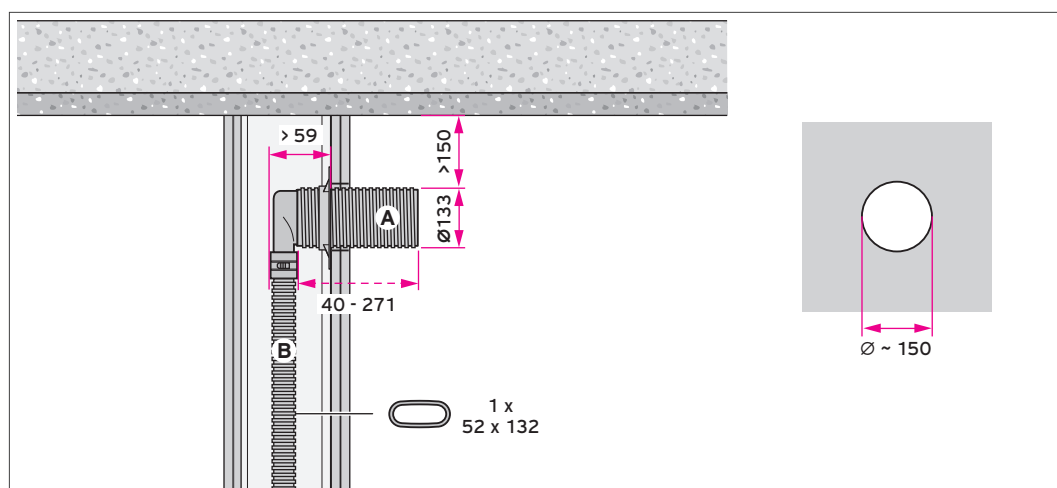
Luftein-/auslass Verlegung in einer Leichtbauwand - Anschluss mit zwei runden Schläuchen
